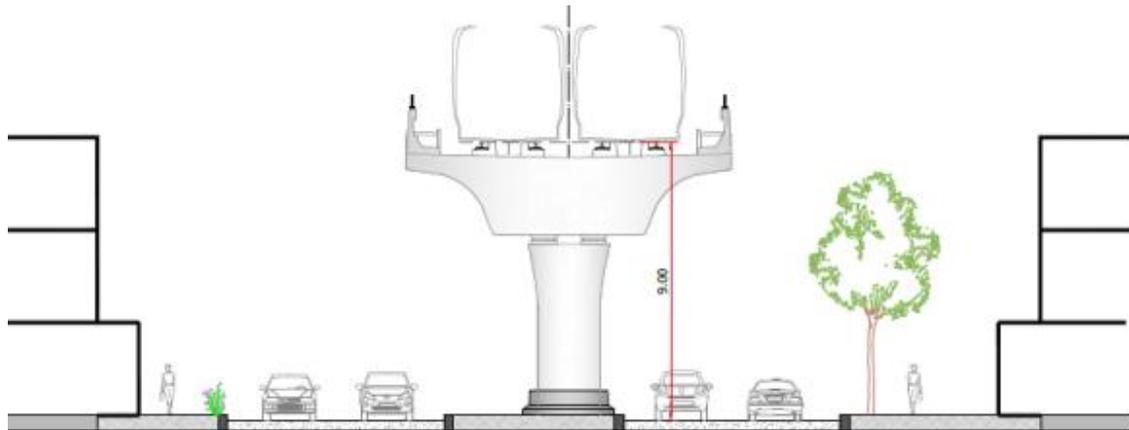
Sección tipo Calle 8 Sur con inserción centrada entre los límites de fachada de construcciones existentes – Fuente: SYSTRA
